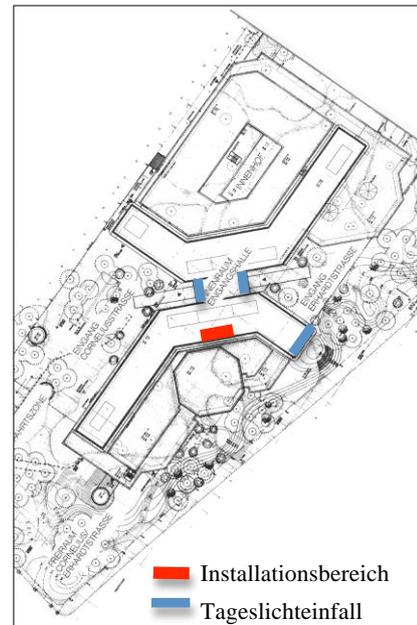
Markierung des Installationsbereichs im Grundriss des Gebäudes mit Himmelsrichtungen und Tageslichteinfall.
